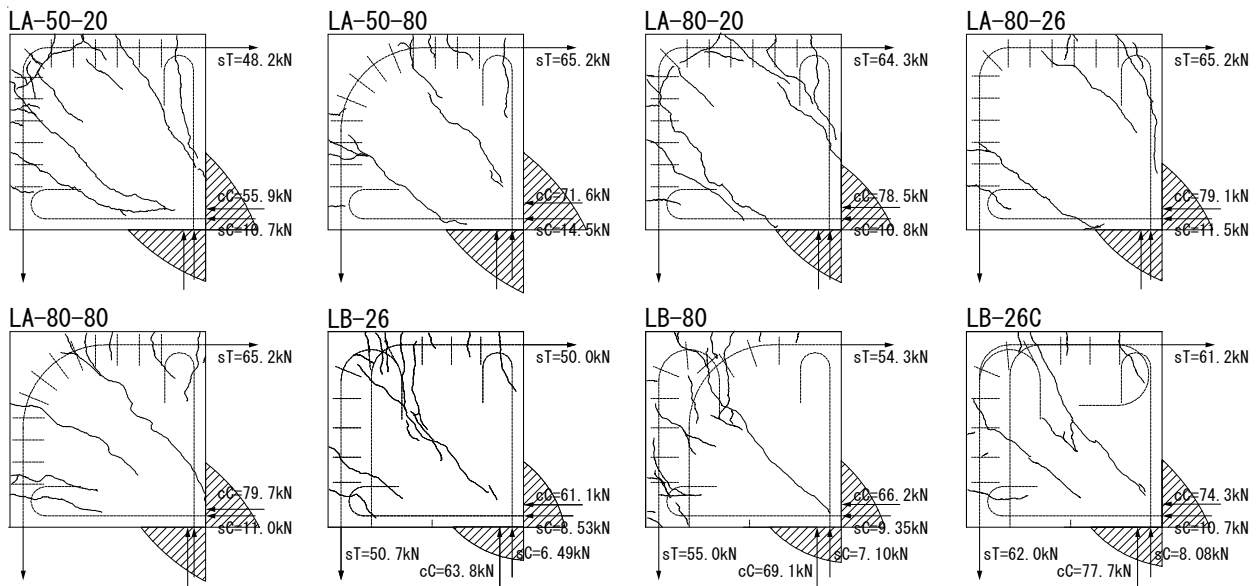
最大耐力または部材降伏時のひび割れ状況と応力状態
